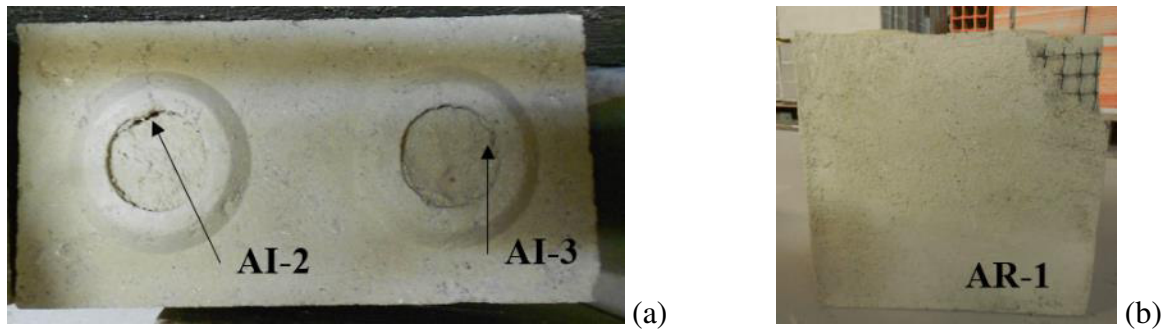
Aparecimento de fissuração nos provetes após algum tempo de cura: (a) Aplicação da argamassa de assentamento/preenchimento AI-2 e AI-3; (b) Aplicação da argamassa de reboco AR-1.
